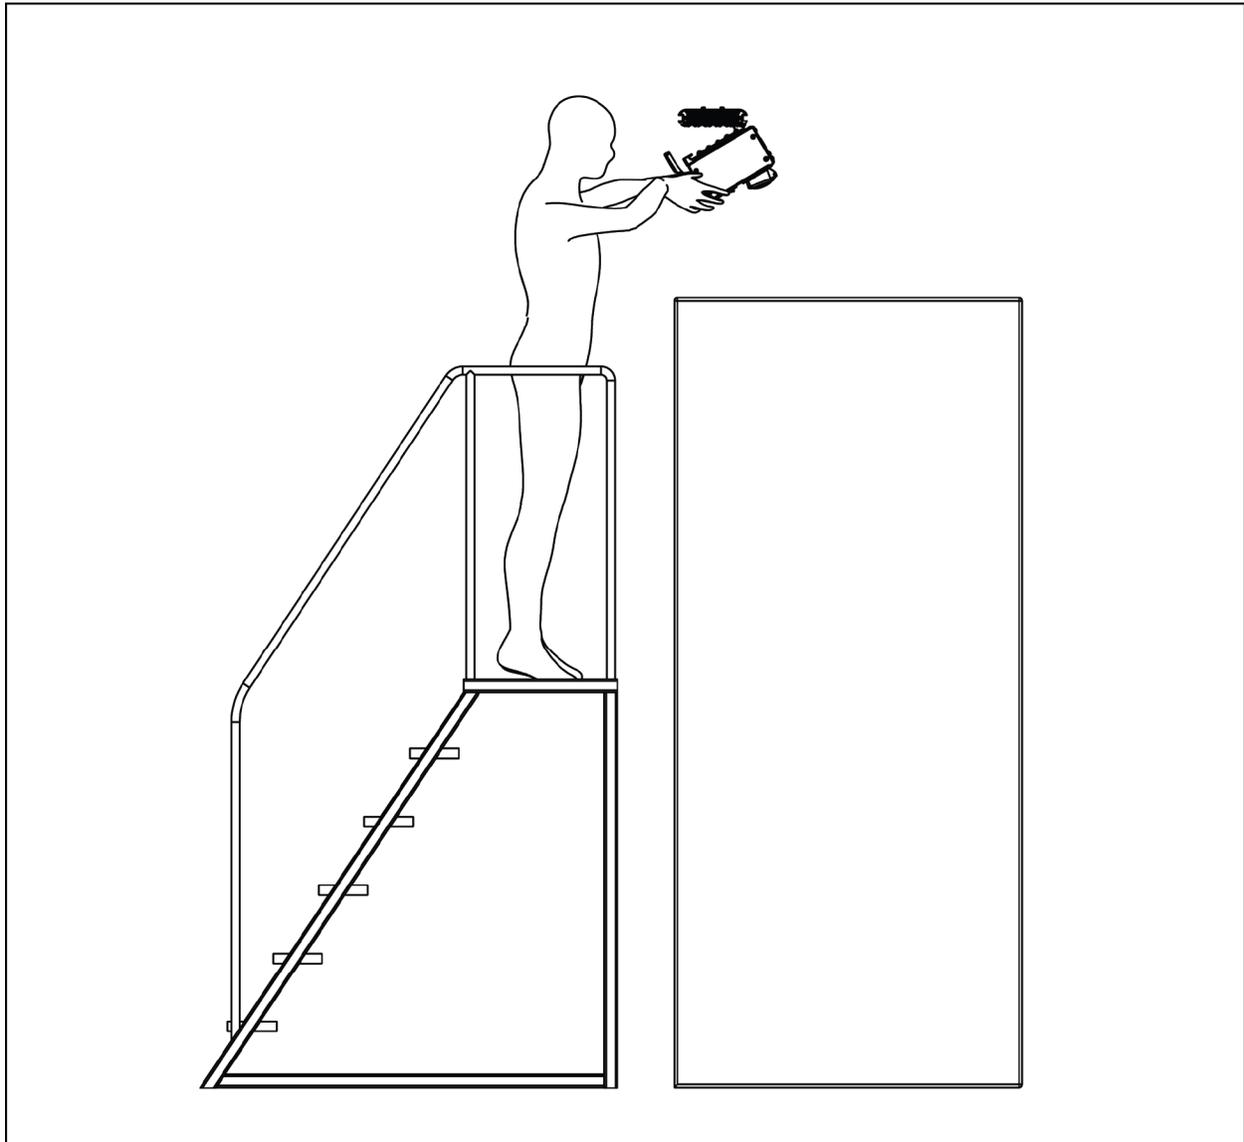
Esempio di installazione della cassetta di derivazione: sopra il rack con impianto doppio di blindosbarra orizzontale, impilati
